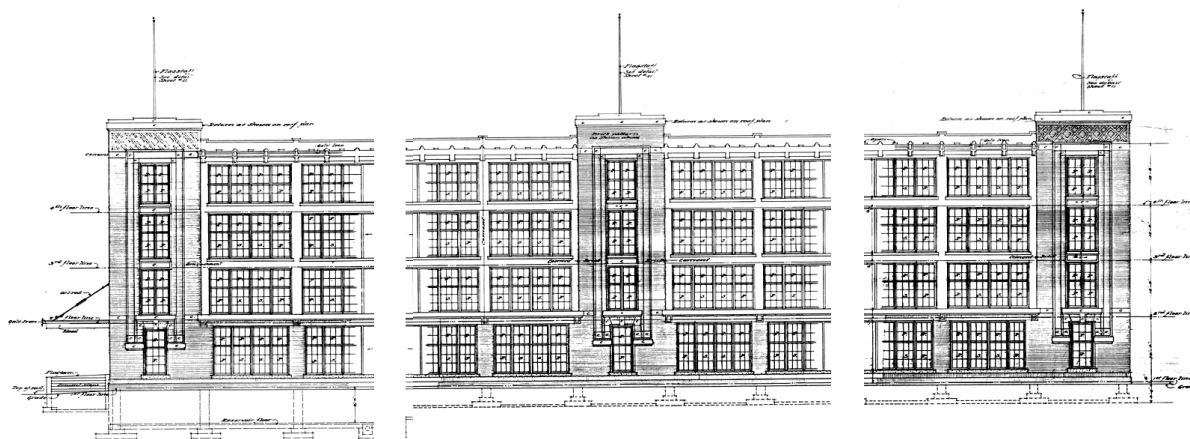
Fachada sobre a Woodward Avenue (pormenores do desenho original, in BHL).
